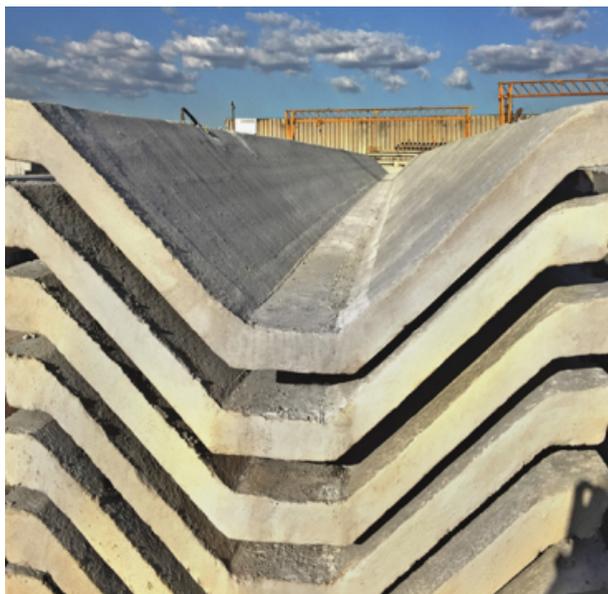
Telhas em concreto protendido (Fonte: Site da Cassol/distribuição gratuita, 2024)
